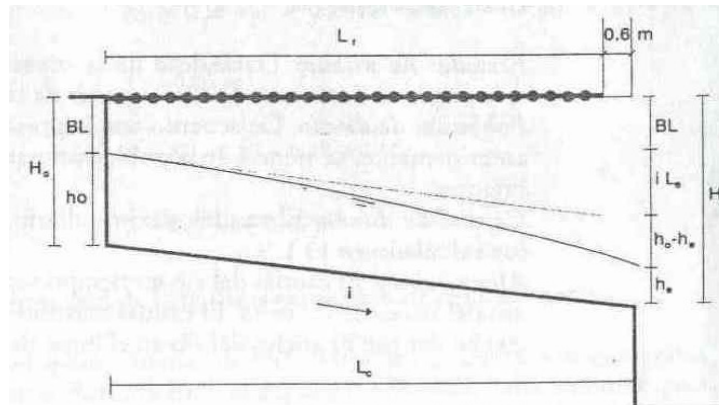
Perfil del canal de aducción (López Cualla, 1995)
